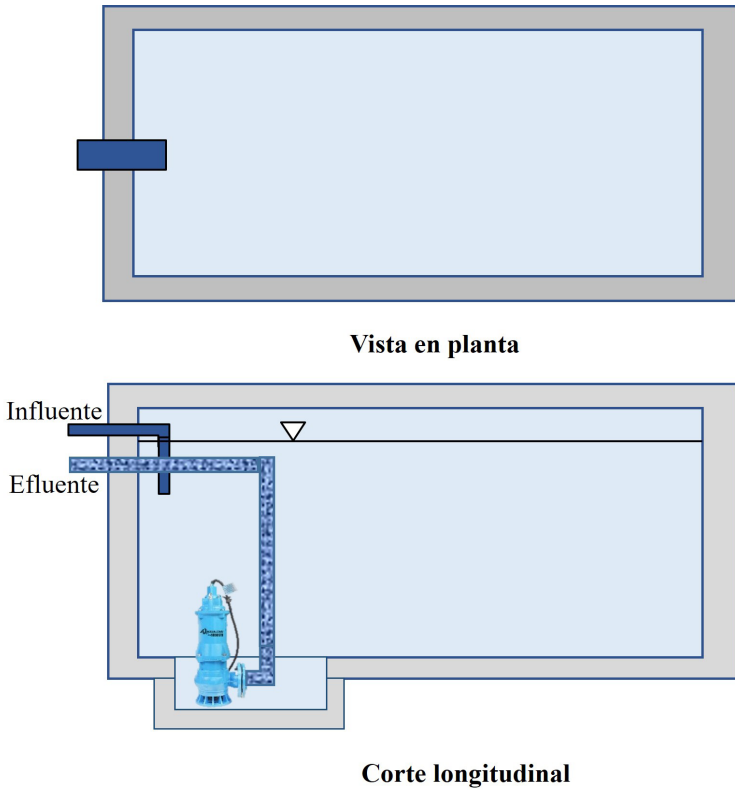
Corte longitudinal y vista en planta del tanque regulador.
